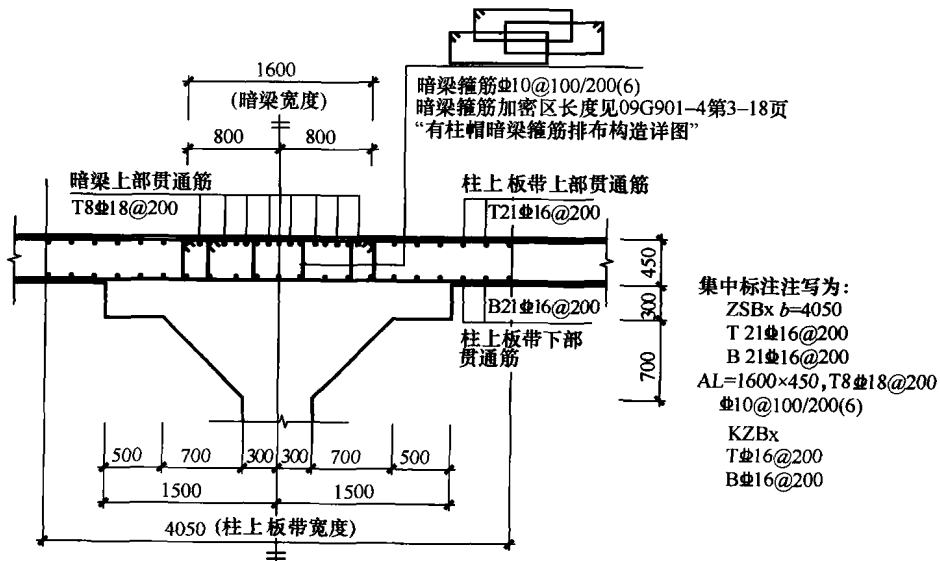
柱上板带配筋剖面及 ZSB 和 KZB 配筋集中标注
